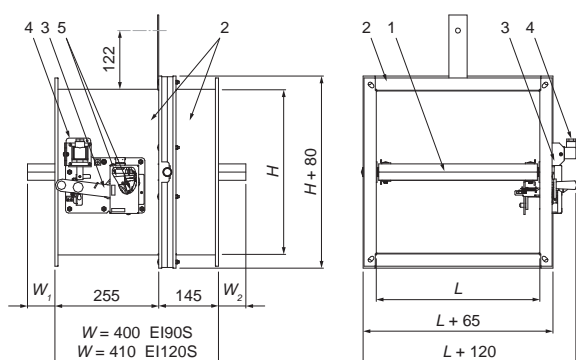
Конструкция противопожарного клапана с электромагнитным приводом для размеров из табл. 3
